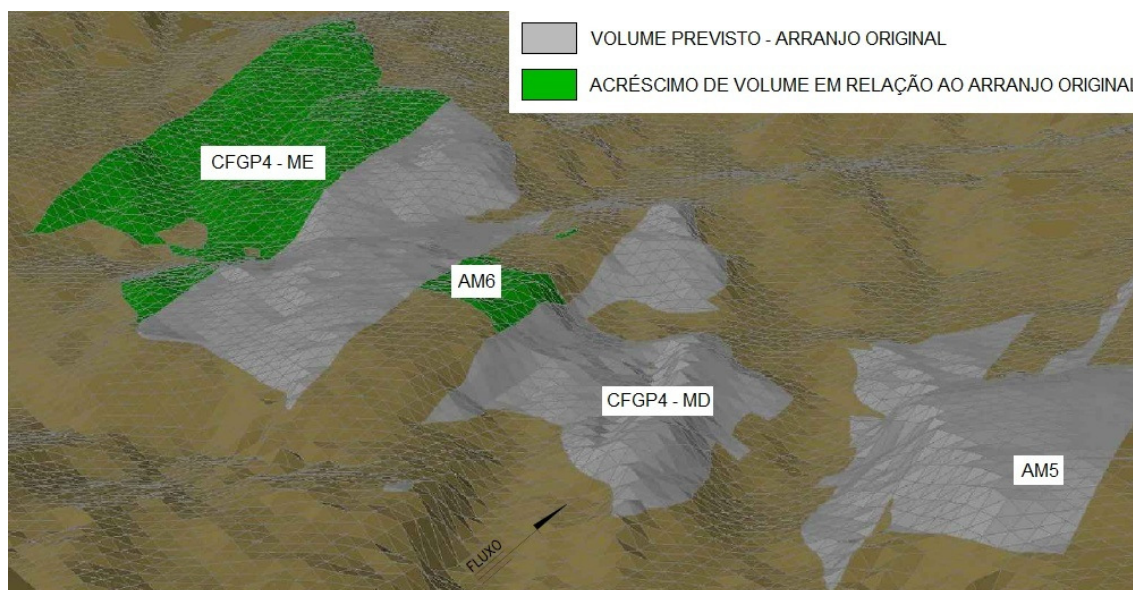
Vista Montante - Escavação - Motorização adicional (6 UG's).
